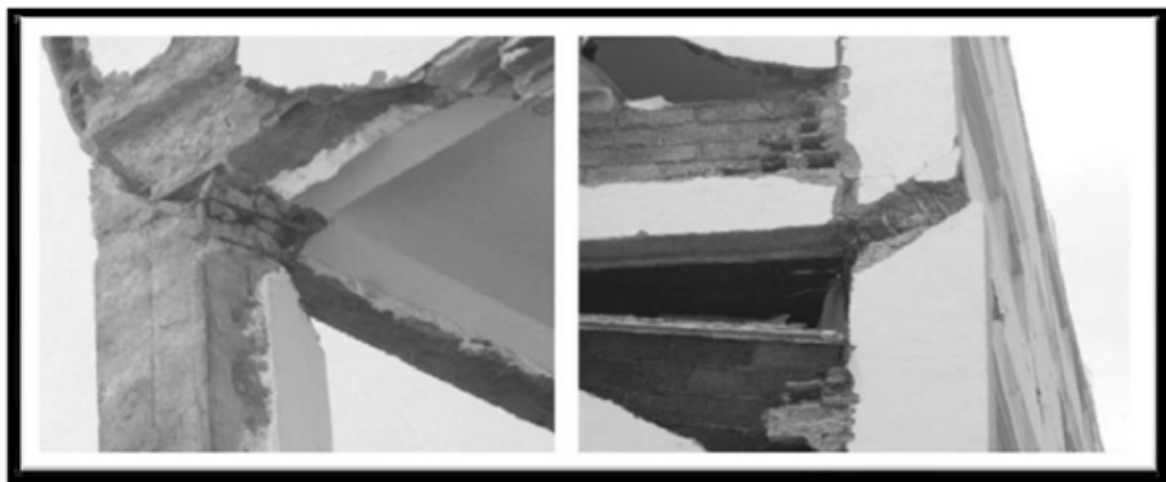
Cisaillement des poteaux par les bielles développés dans la maçonnerie insérées.
